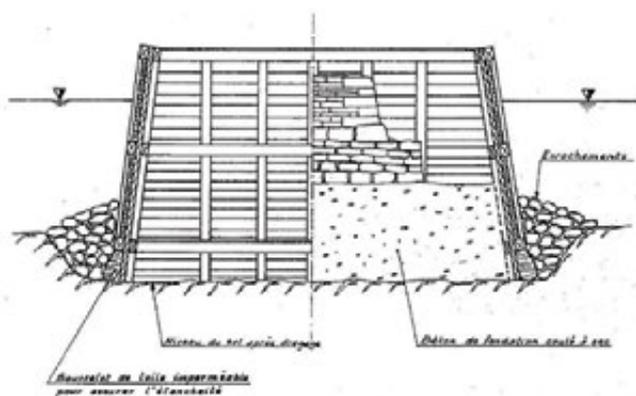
Fondation par caisson étanche échoué sur les fonds (ministère des transports 1980)
